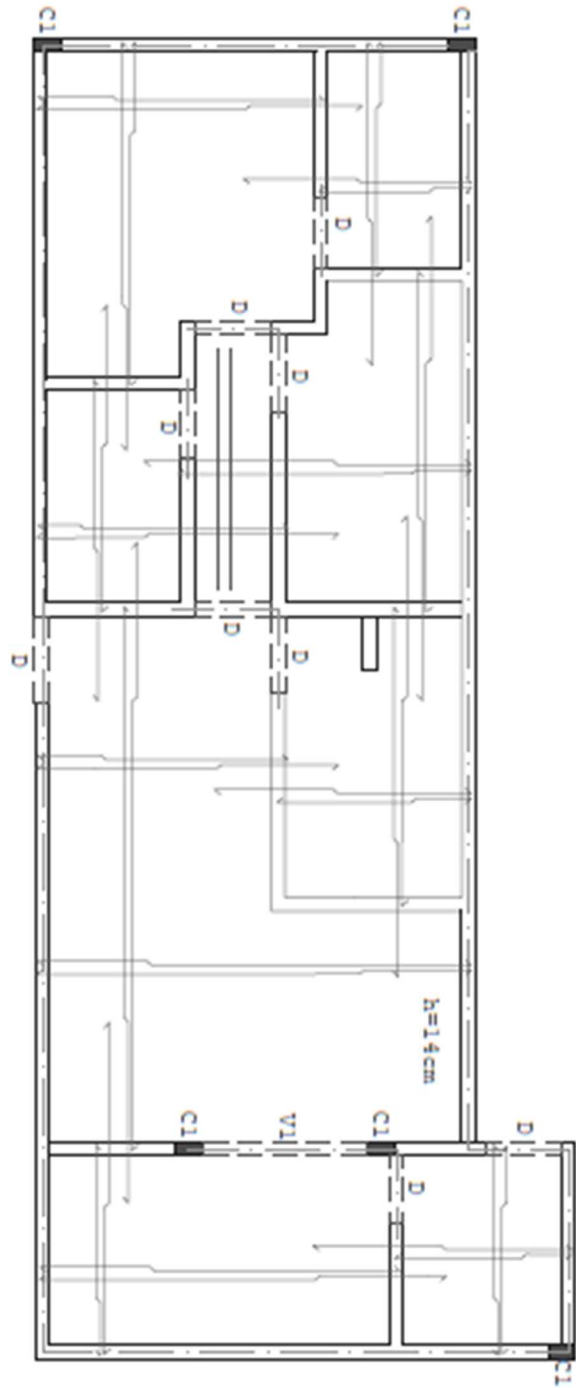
Diseño Estructural para Vivienda en Mampostería – Vigas y Dinteles
